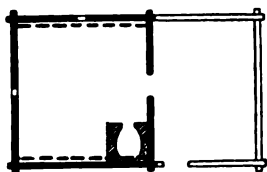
Grundriss der rauchpörte abb. 7.
